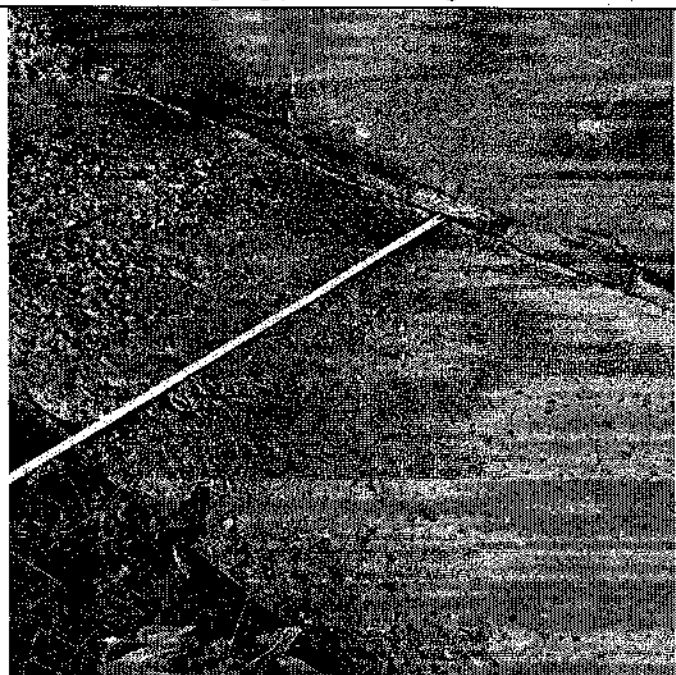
,4. Наличие трещин и локальных разрушений отмостки здания. Отхождение отмостки от стен жилого дома.
